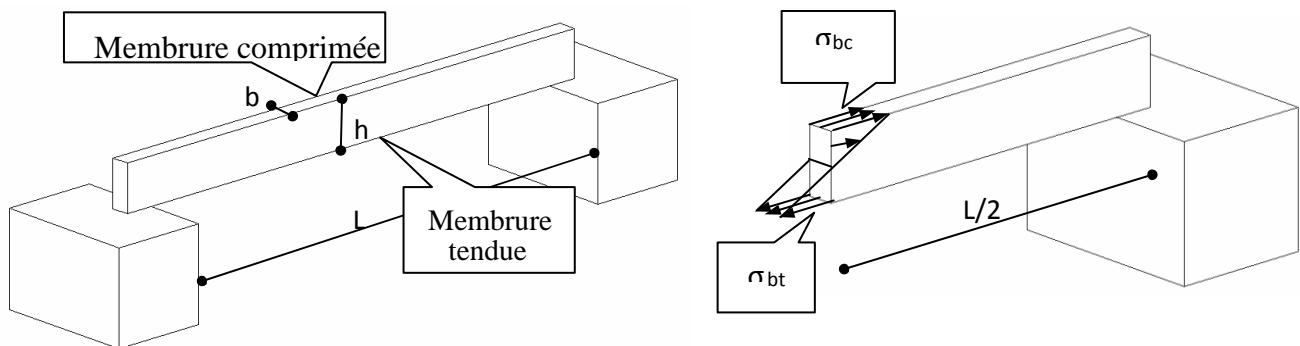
Poutre en béton non armé, de section droite rectangulaire $b \times h$, franchissant une portée de L mètres de nu à nu des appuis.
